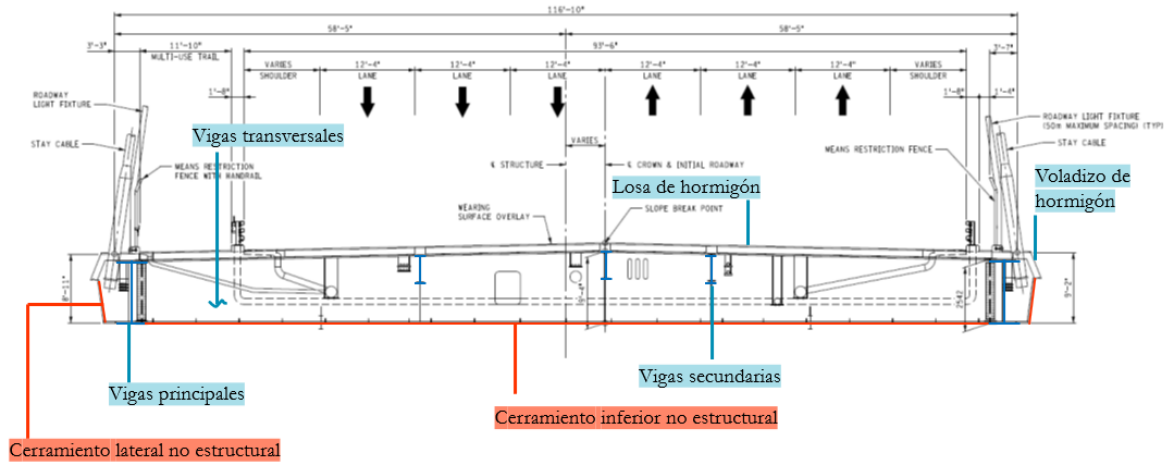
Sección transversal – Elementos estructurales y no estructurales.
